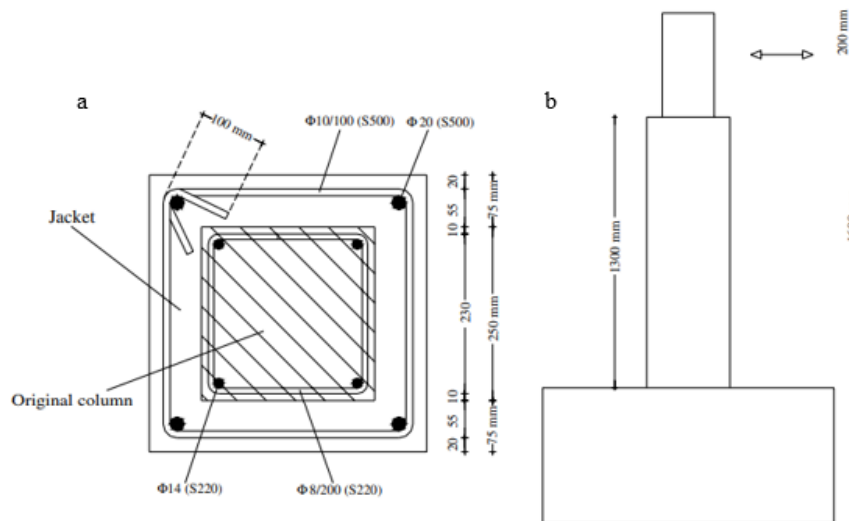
Geometría característica de las columnas encamisadas de Vandroros y Dritsos (2006)
